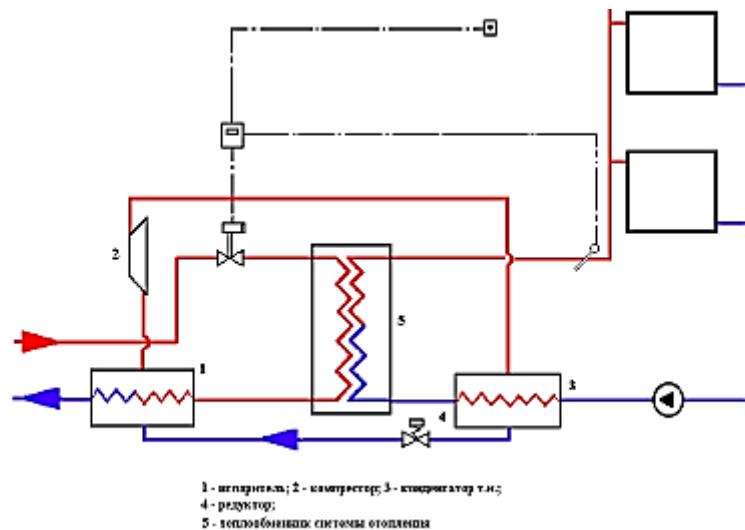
Схема теплового пункта с тепловым насосом и конденсатором на обратном трубопроводе системы отопления
